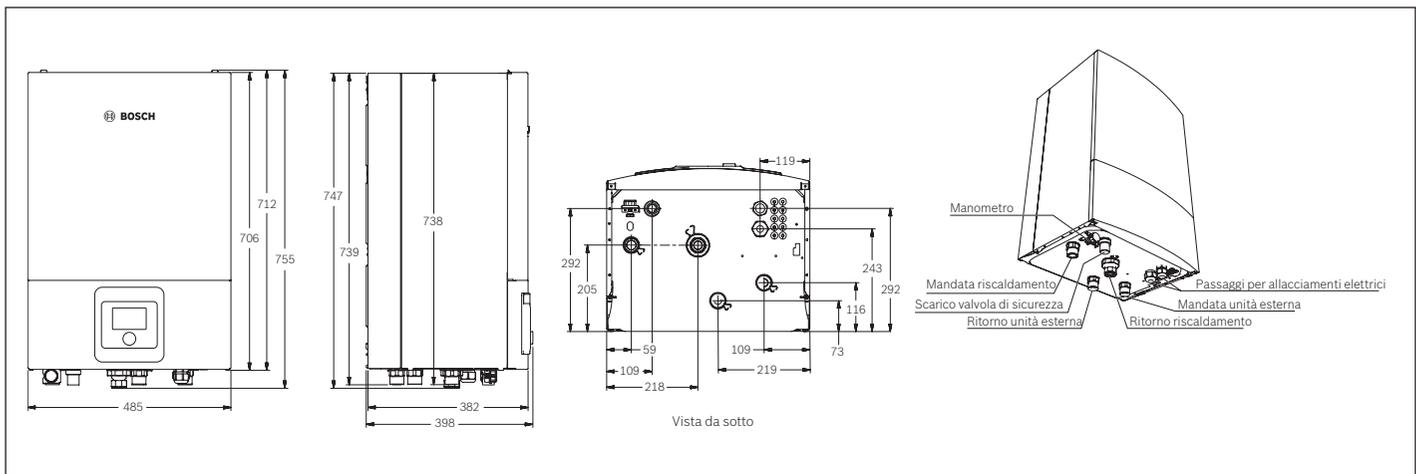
Dimensioni e attacchi di collegamento unità AWE
